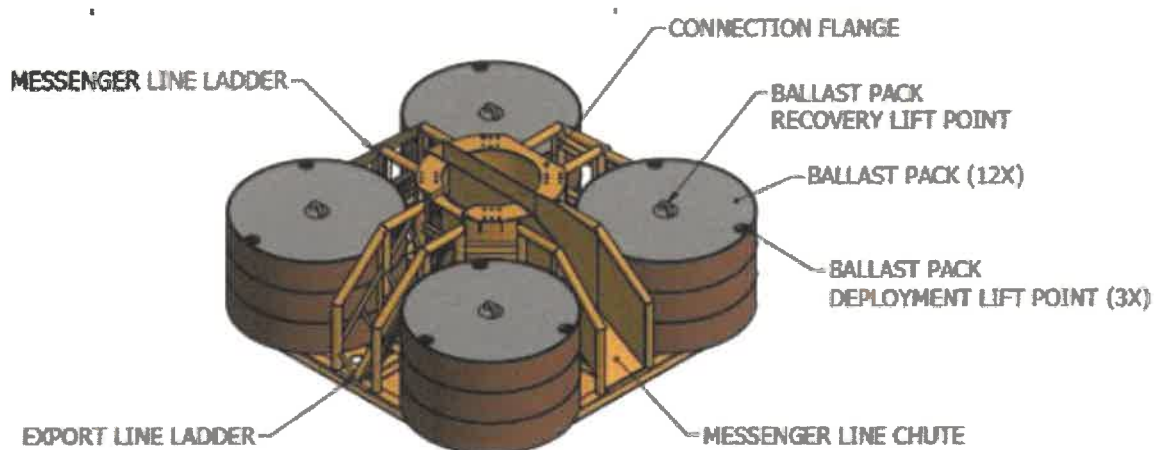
Exemple de fondation par gravité (la configuration et la taille finales dépendent de la conception finale).
